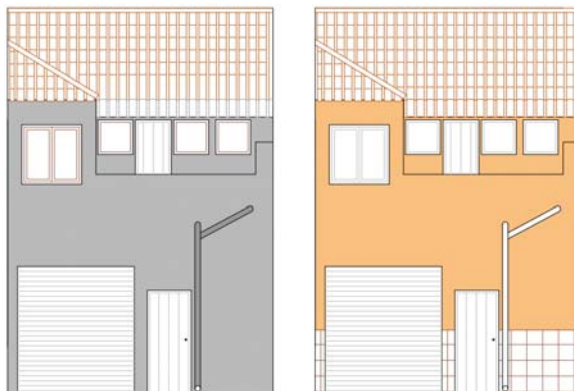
Propuesta de intervención fachada posterior. Fuente propia.
